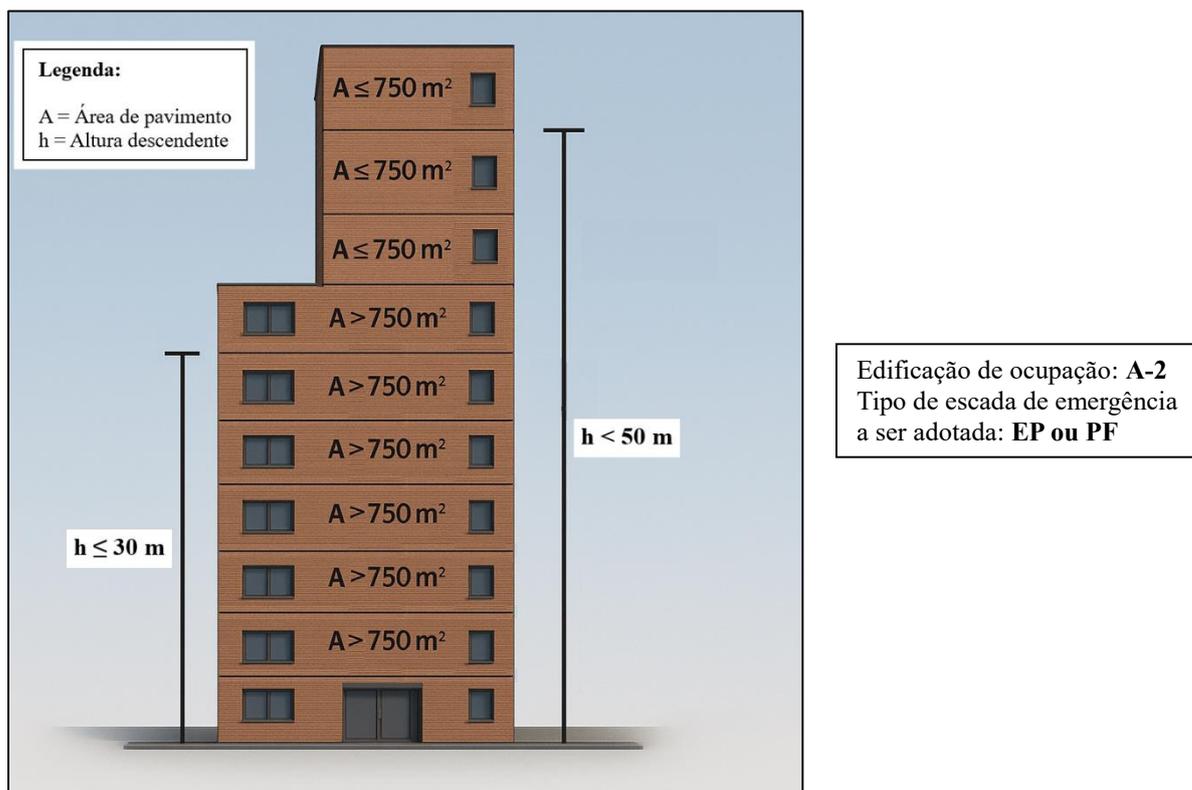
Ilustração do disposto no art. 1º desta Instrução Normativa
